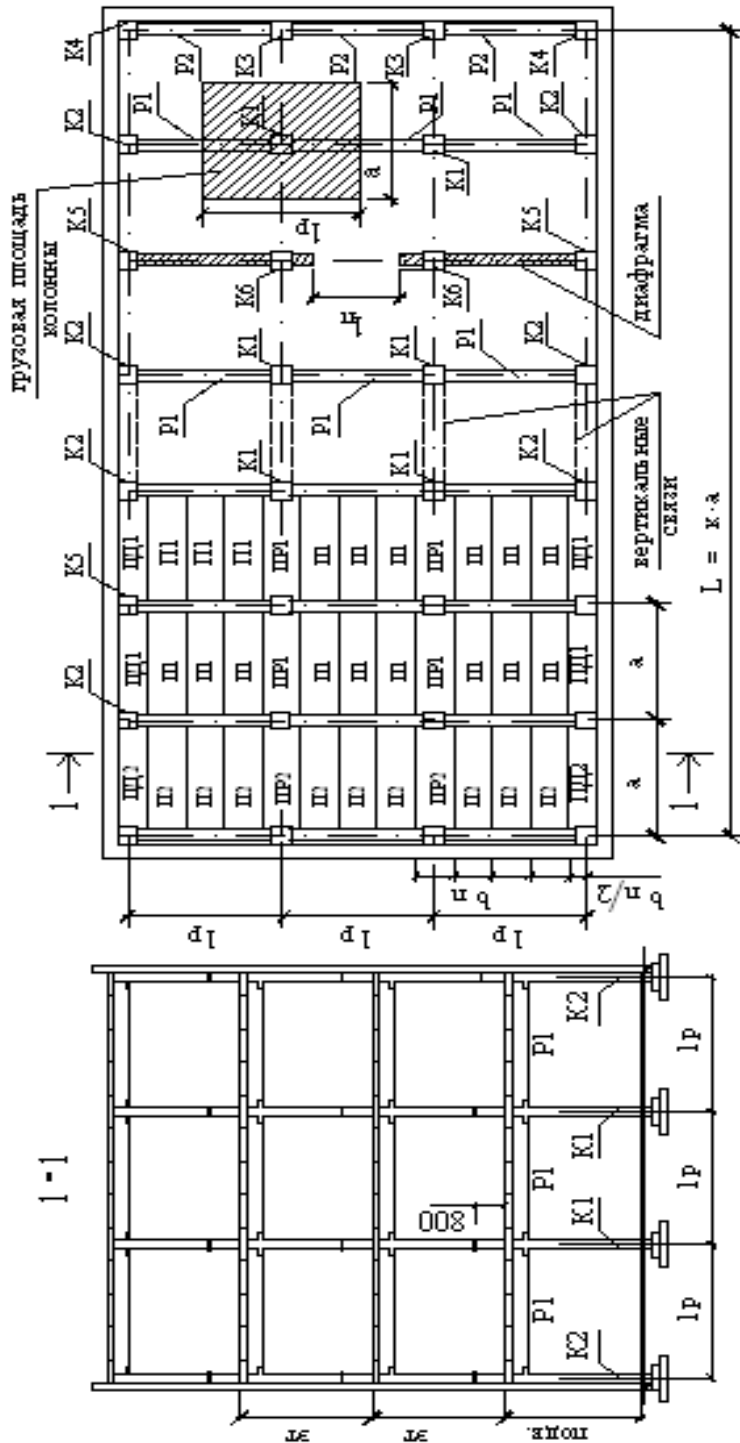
Конструктивный разрез и совмещенный план перекрытия
